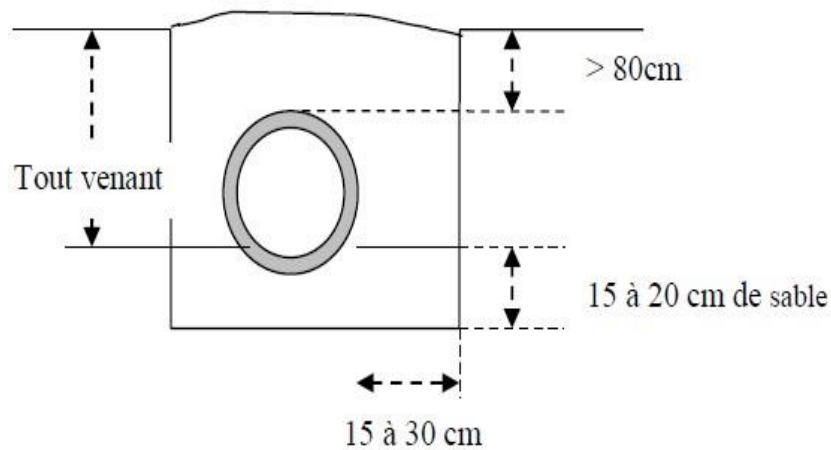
pose de conduite en tranchée dans un terrain ordinaire (b. Saleh 2014)
